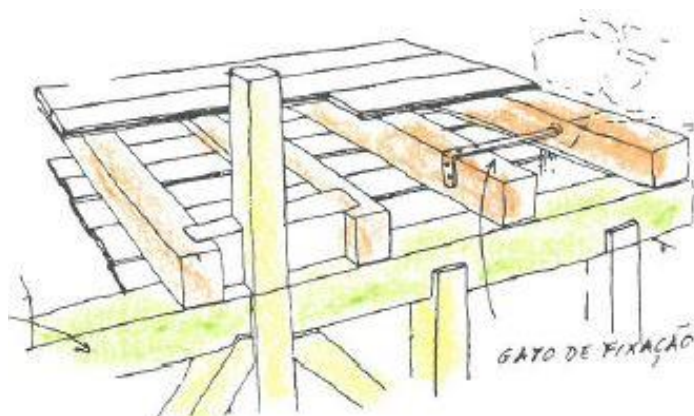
Pormenor de ligação do pavimento com os frechais (Mascarenhas, 2005)
